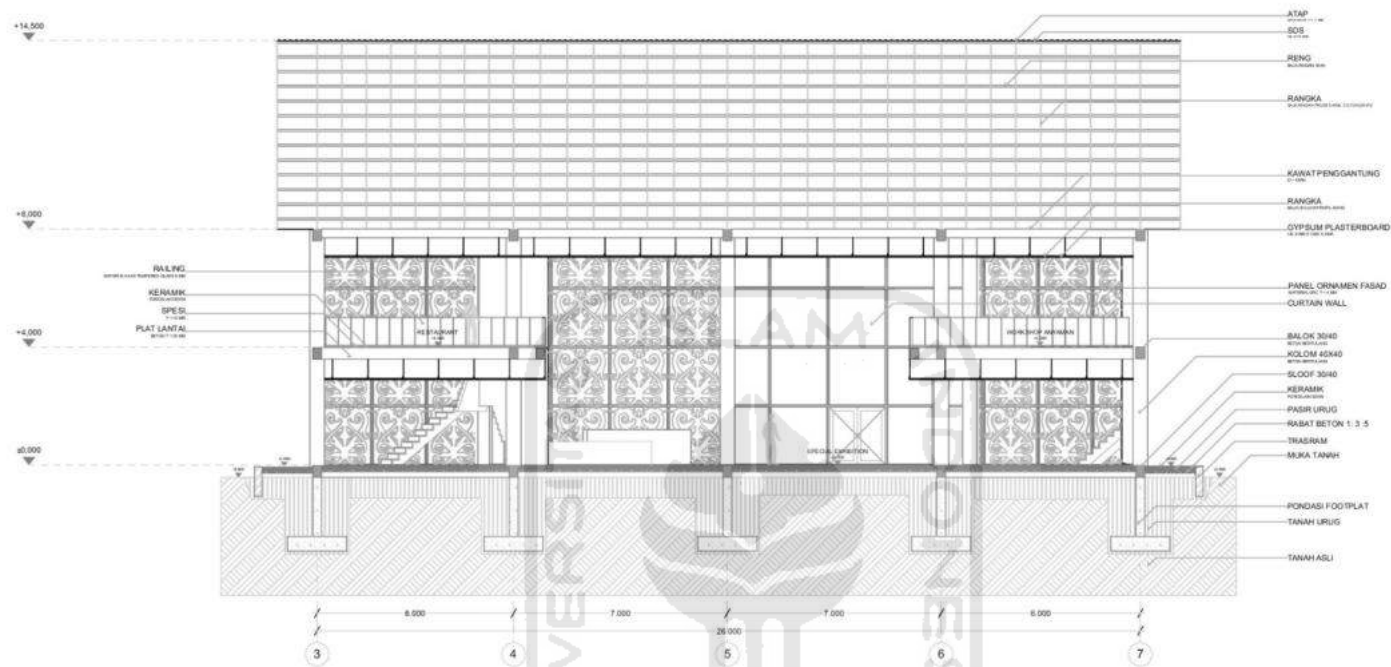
Tampak barat bangunan teater (Sumber: Penulis, 2021)
